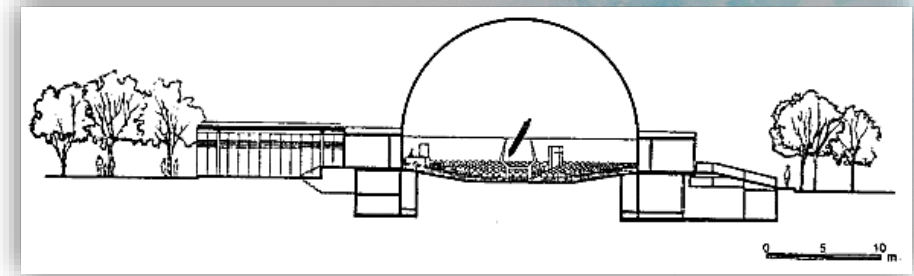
Corte longitudinal del planetario. Fuente: Enciclopedia Plazola.
